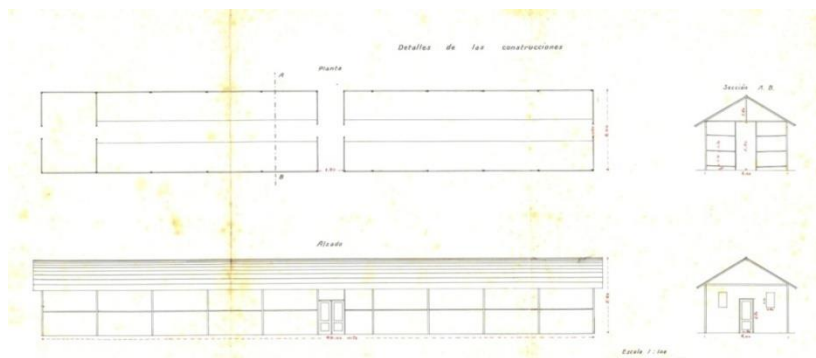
Planta y alzado de los barracones según el proyecto presentado por el ingeniero Jefe interino Francisco Pol el 22 de febrero de 1916. Fuente: AGA. A-G. C 81/7104.
